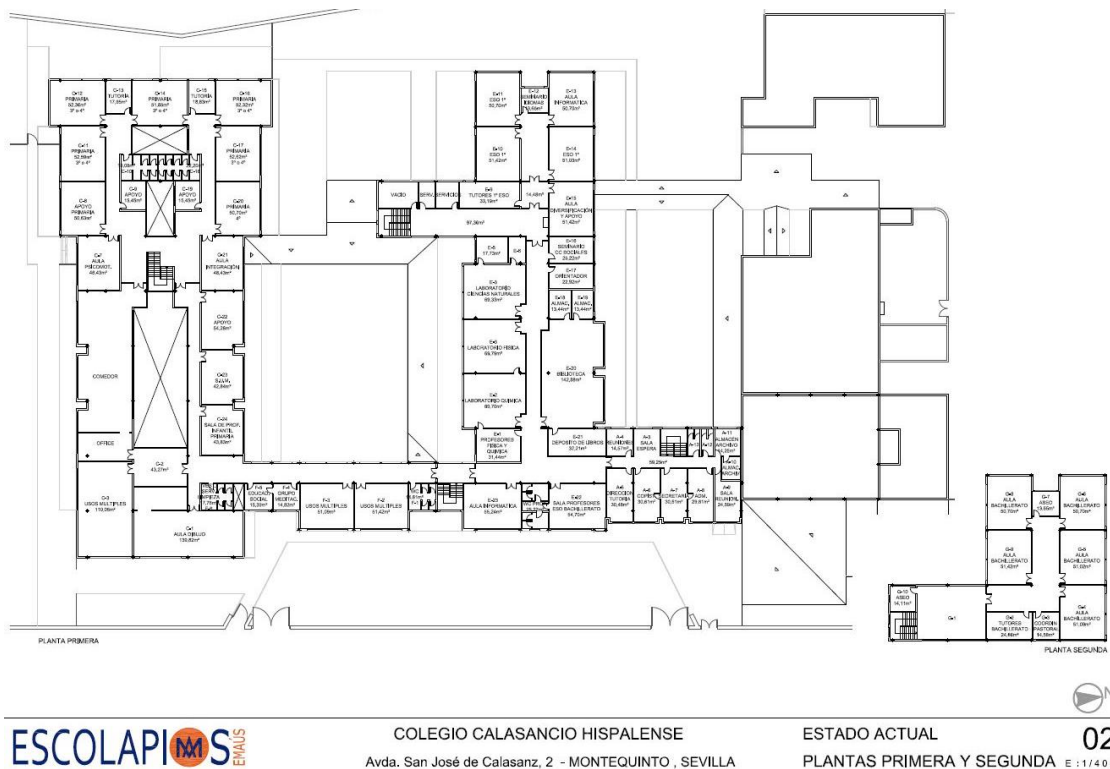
Planta primera del CEIP Calasancio Hispalense. Planos aportados por el centro. Fuente: Escolapios Emaús
